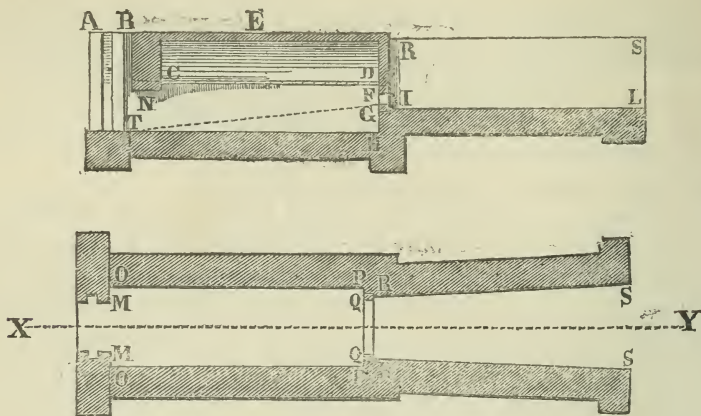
Pianta e sezione della bocca magistrale milanese.
